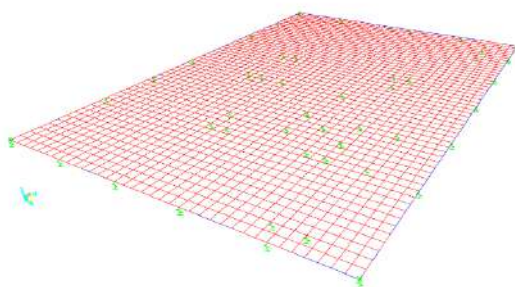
Modelo de cálculo da laje de ensoleiramento geral.
